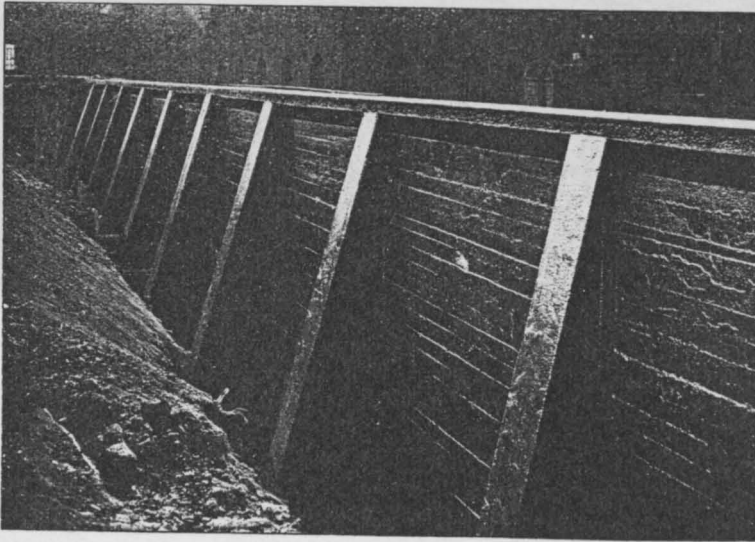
Eisenbetonstützmauer. (Rückansicht.)
